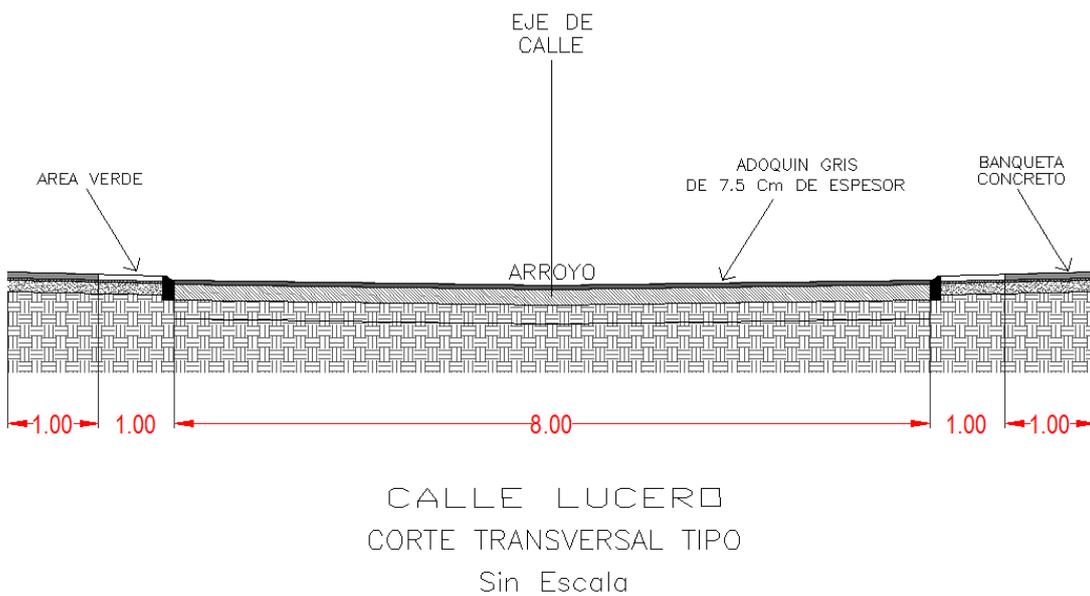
Sección tipo para la adecuación de la calle “Lucero”.
